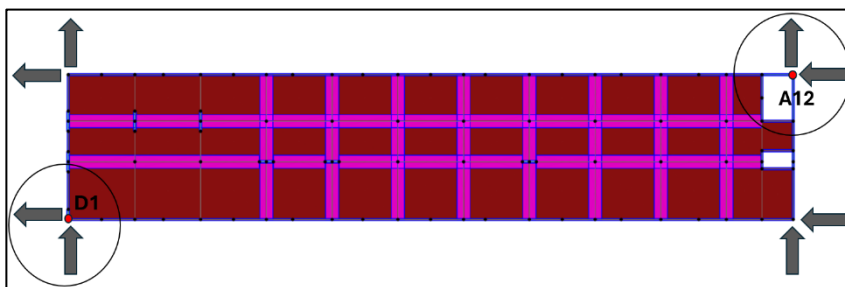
Pavimento rígido no plano XY ($Z=0$) do modelo computacional utilizado.
